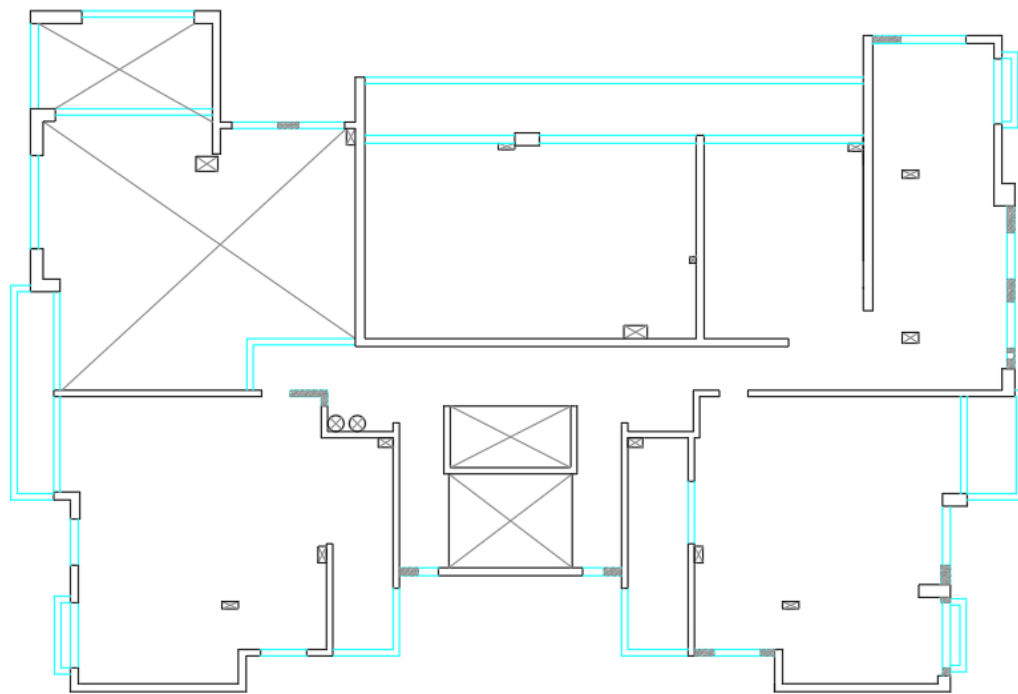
Adaptación de plano estructural de planta del piso 1.
